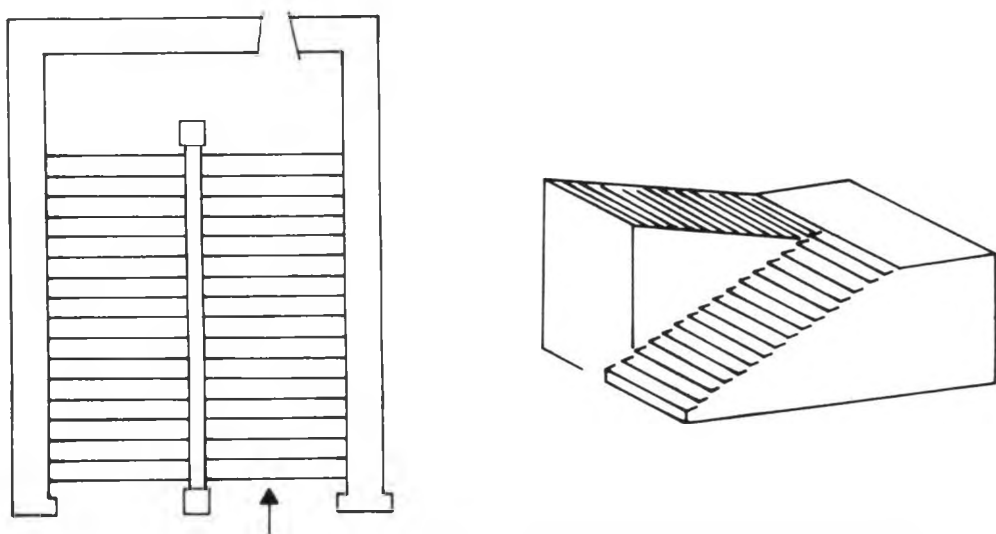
Planta y alzado de la escalera interior del Palacio de Grajal de Campos (León).
